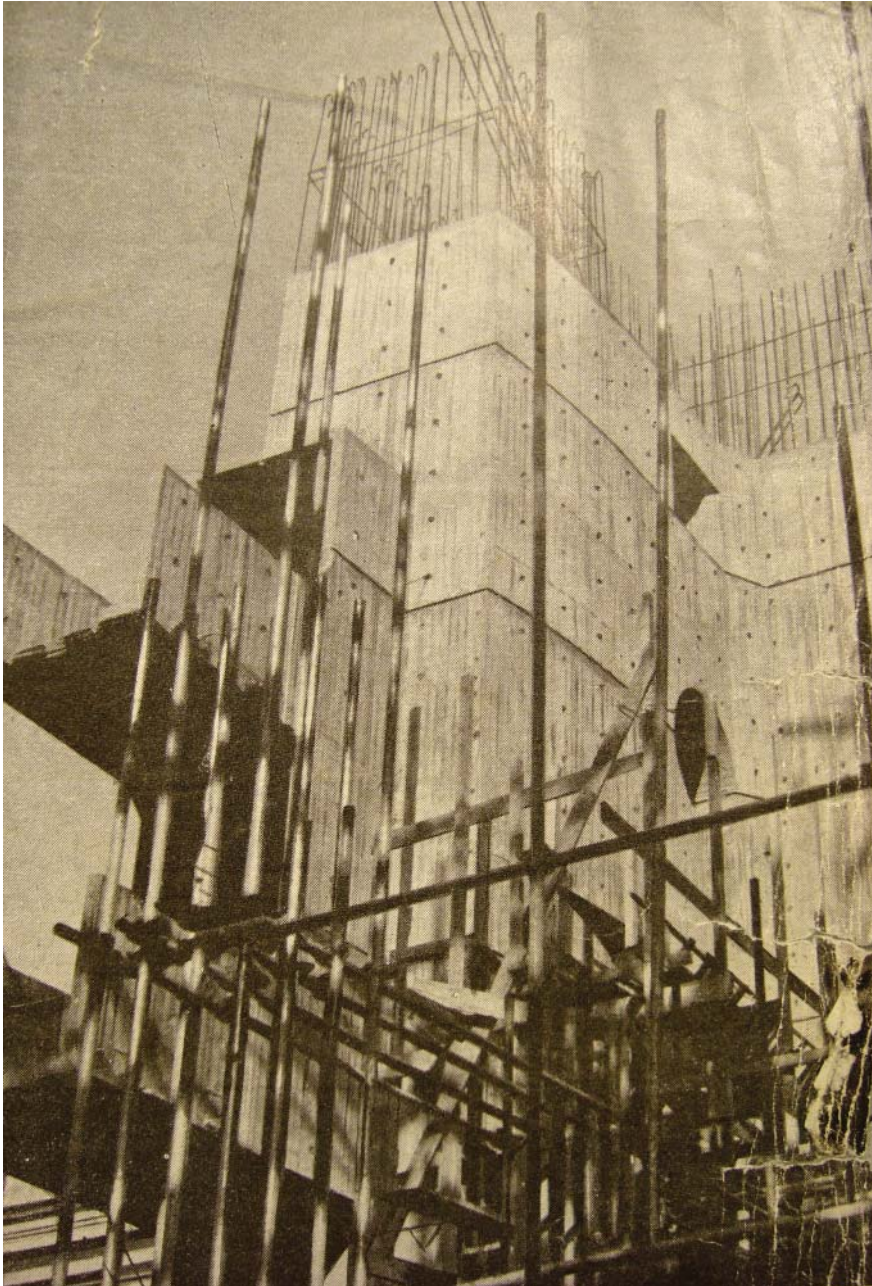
Banco de Londres, em construção. (Fonte: Construcciones. n.191, 1964.)
